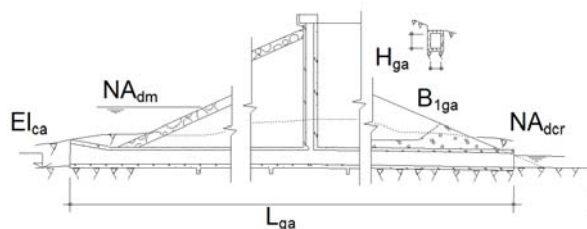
Seção longitudinal e transversal de galeria de desvio na barragem.
